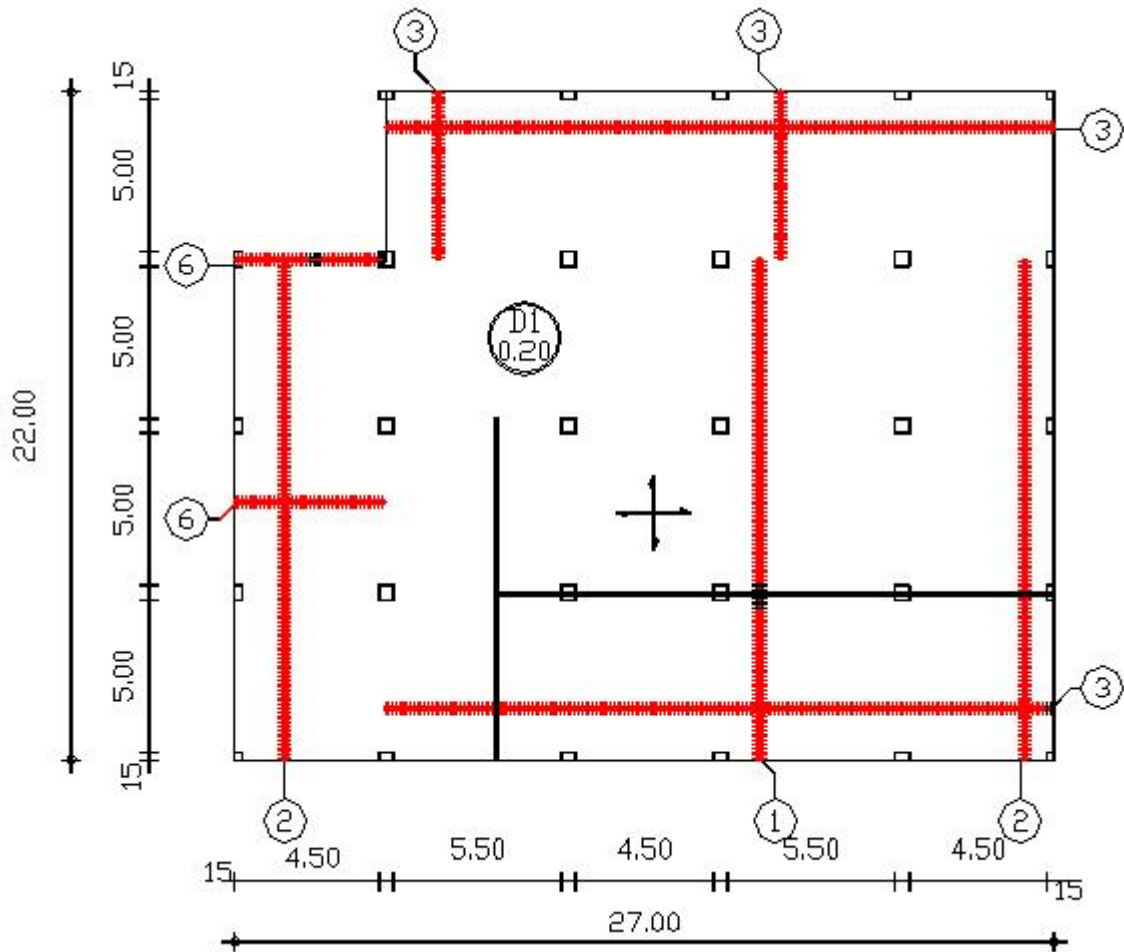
Ferrailage de dalle (les nappes inferieures)
